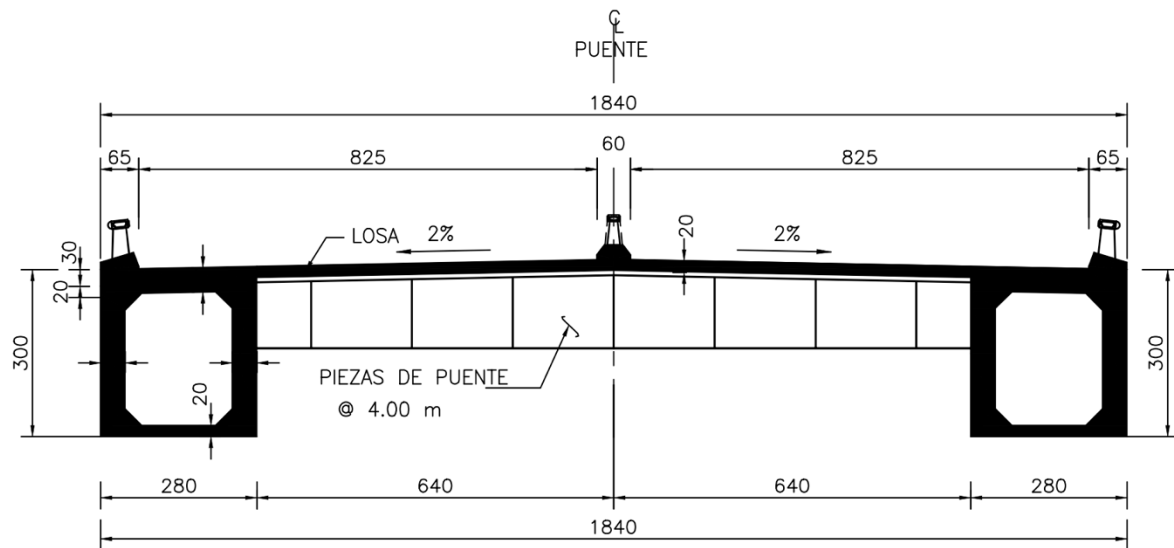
Sección transversal mínima Pila No.3. [cm]
